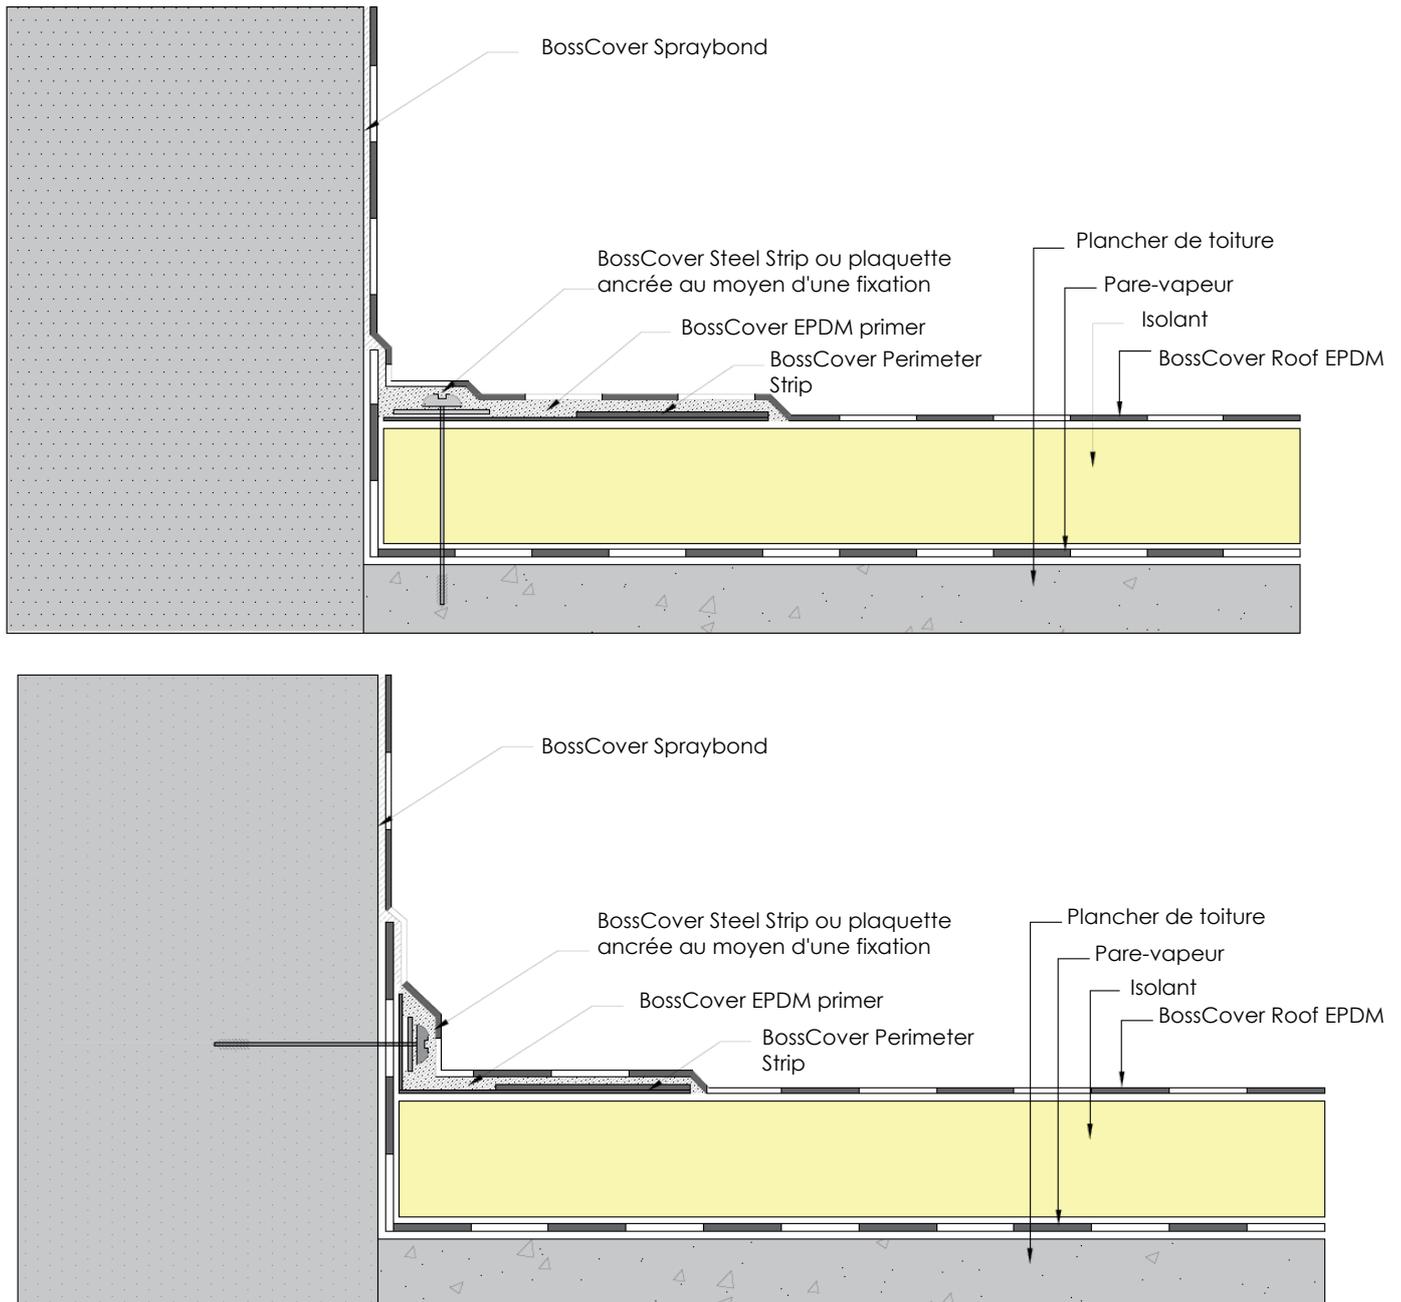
Fixation au droit de l'angle de l'acrotère au moyen d'une bande BossCover Perimeter Strip
